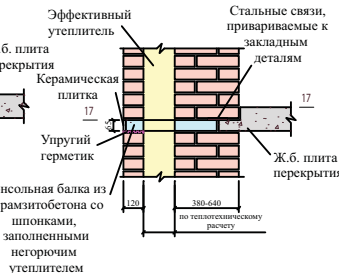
в Междуюконный пояс наружной стены высотой до 18 этажей с самонесущим внутренним и с несущим наружным слоем, устанавливаемым на консольную балку из керамзитобетона (тип ГН-4)
